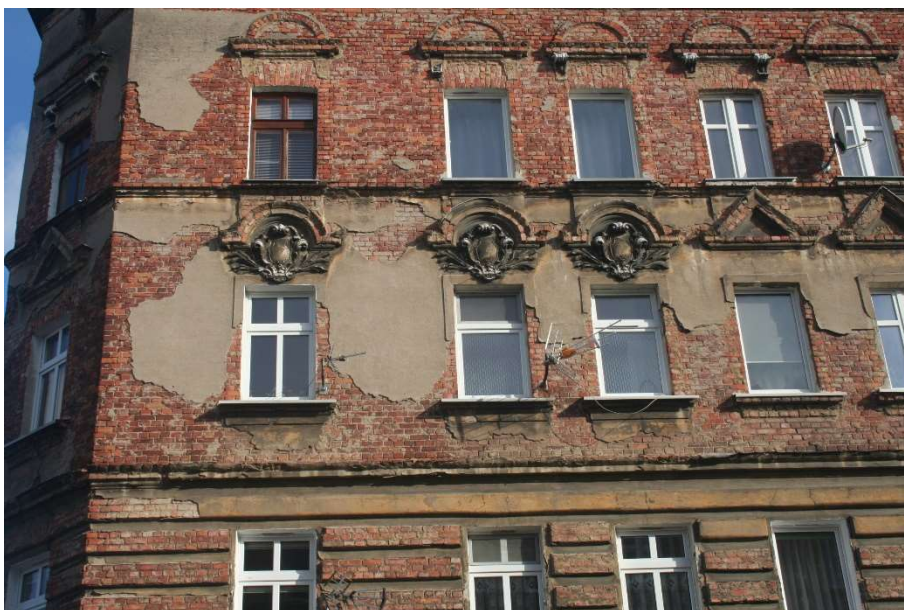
Miejscowe przemurowania, odtworzenie części elewacji
